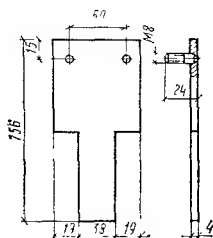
Пластина типа 26кс (масса 0,29 кг) для крепления стальных кронштейнов умывальников на кирпичных и бетонных стенах дюбель-гвоздями
